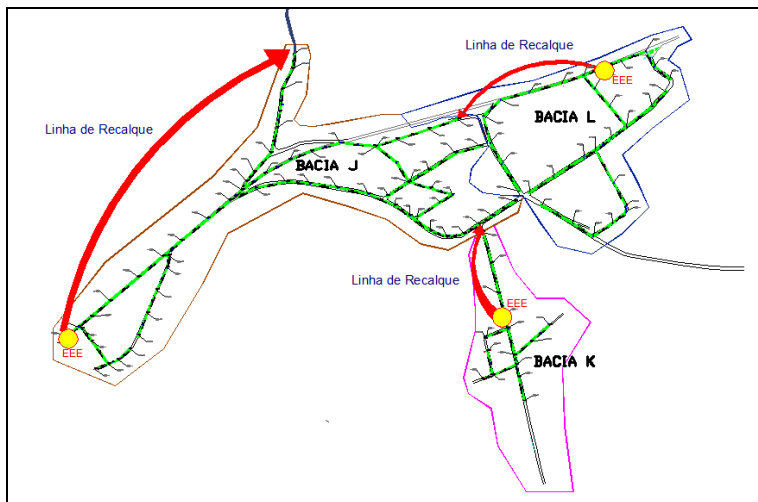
Detalhe das linhas de Recalque da Rede Coletora.
